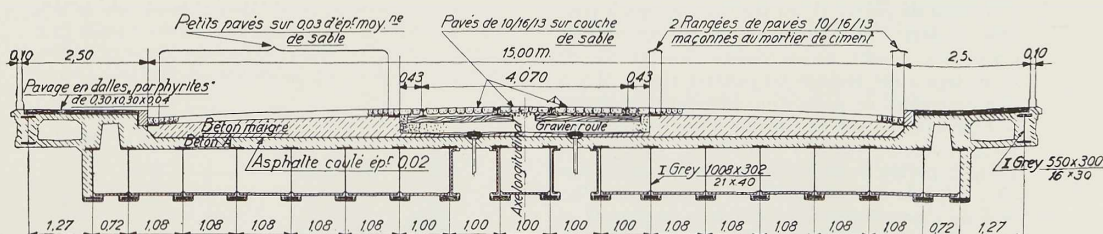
Coupe transversale du passage supérieur de l'Avenue de la Reine.
